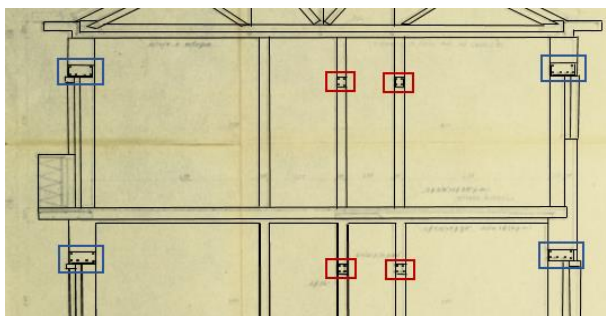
13 - Corte na secção transversal (sentido Y) do edifício com representação das vigas de betão armado por cima das janelas e das portas (Milošević, 2019).
